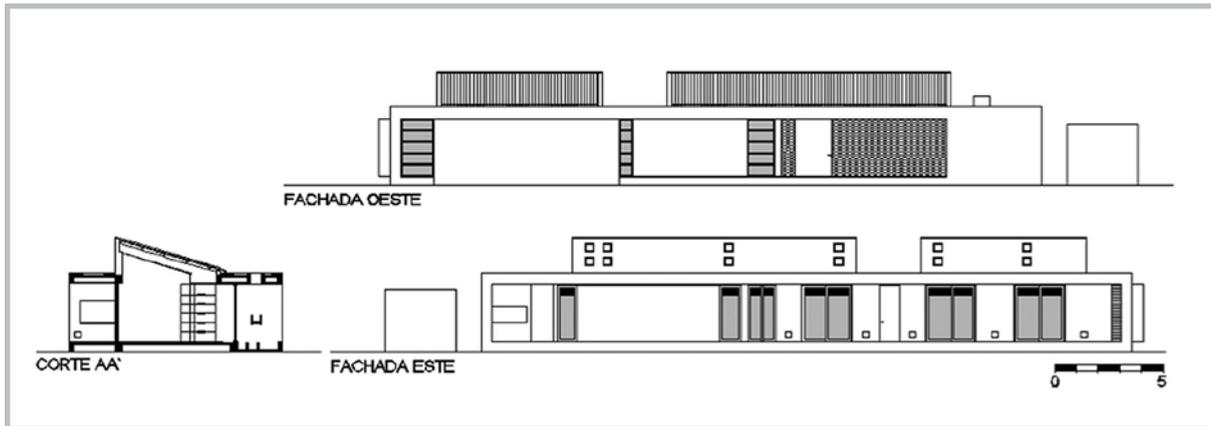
Fachadas y corte “Casa Cárpena Escobar”. Fuente: Planos Oscar Cárpena (2010)
